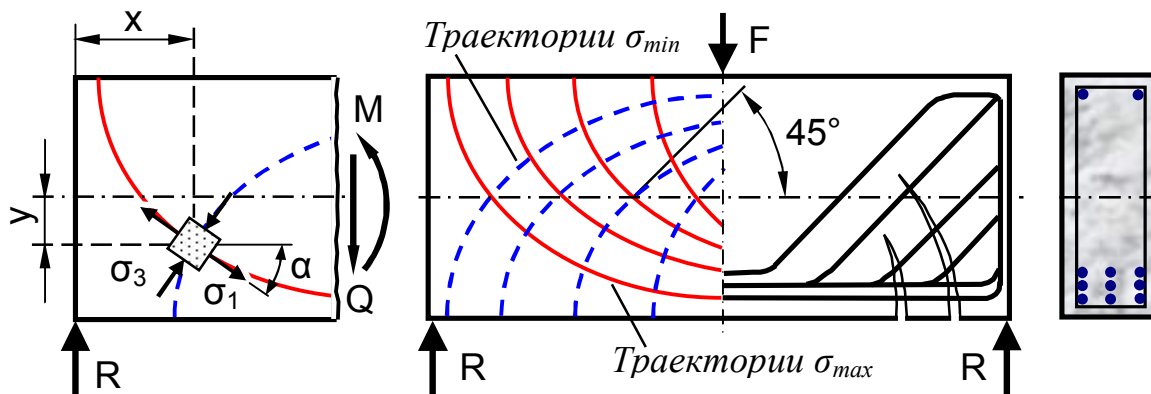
Траектории главных напряжений при изгибе и схема армирования железобетонной балки
